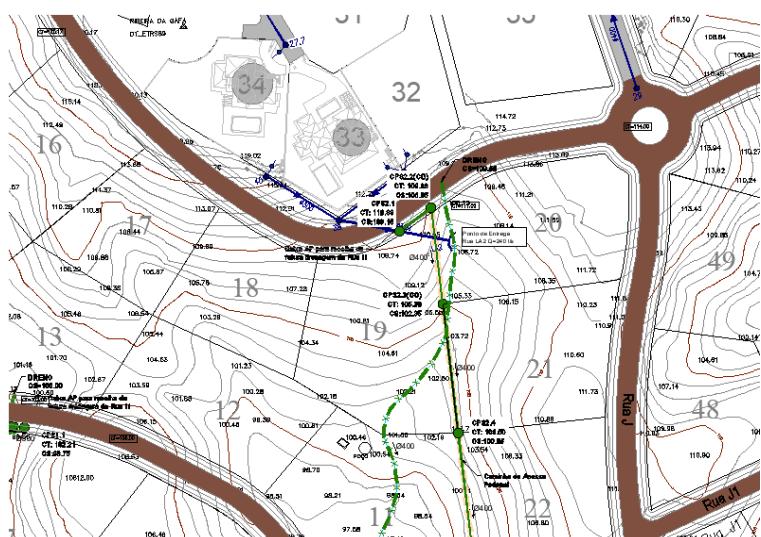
Infraestruturas Existentes de drenagem de águas pluviais a descarregar no terreno natural.
